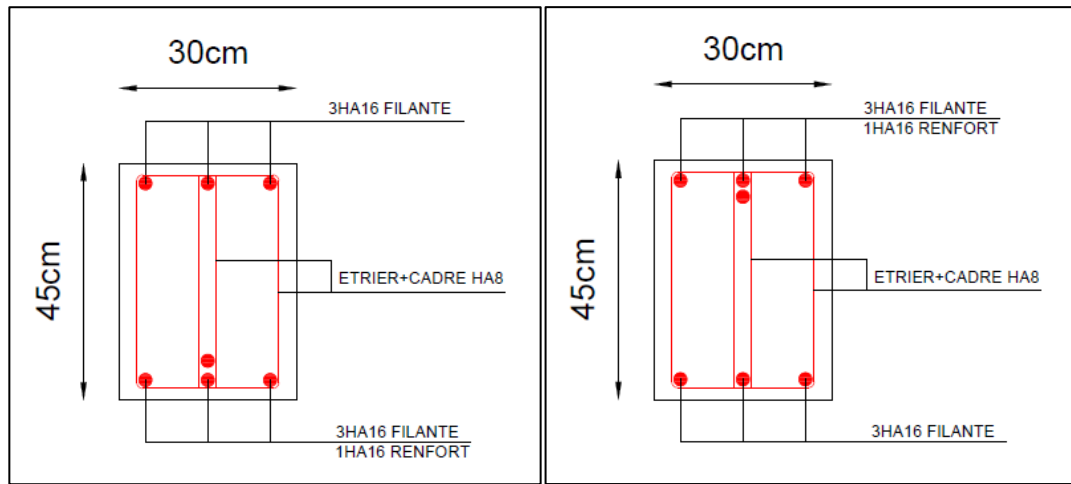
Schéma de ferrailage des poutres principales (30×45) cm selon le calcul à L’E.L.U sur travée et appui.
